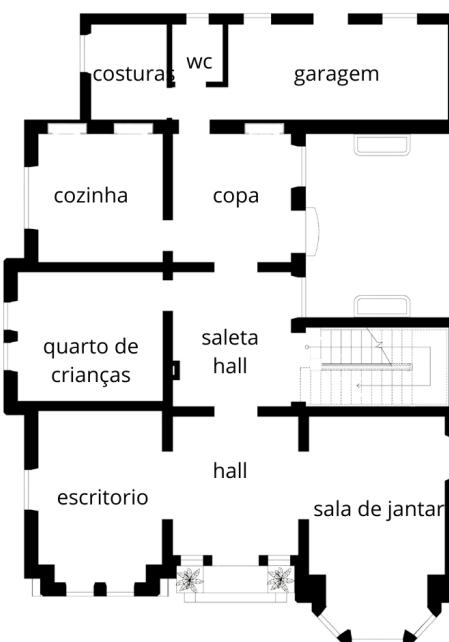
Planta baixa do pavimento térreo da *Villa Stella*, com as divisões dos ambientes.
